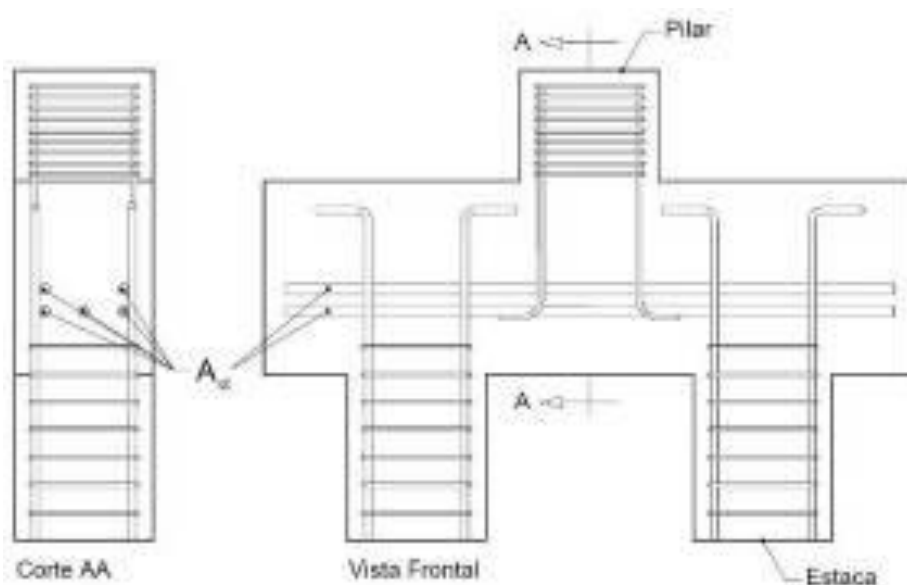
Detalhe esquemático das armaduras dos modelos 2 e 4 sem armadura secundária
